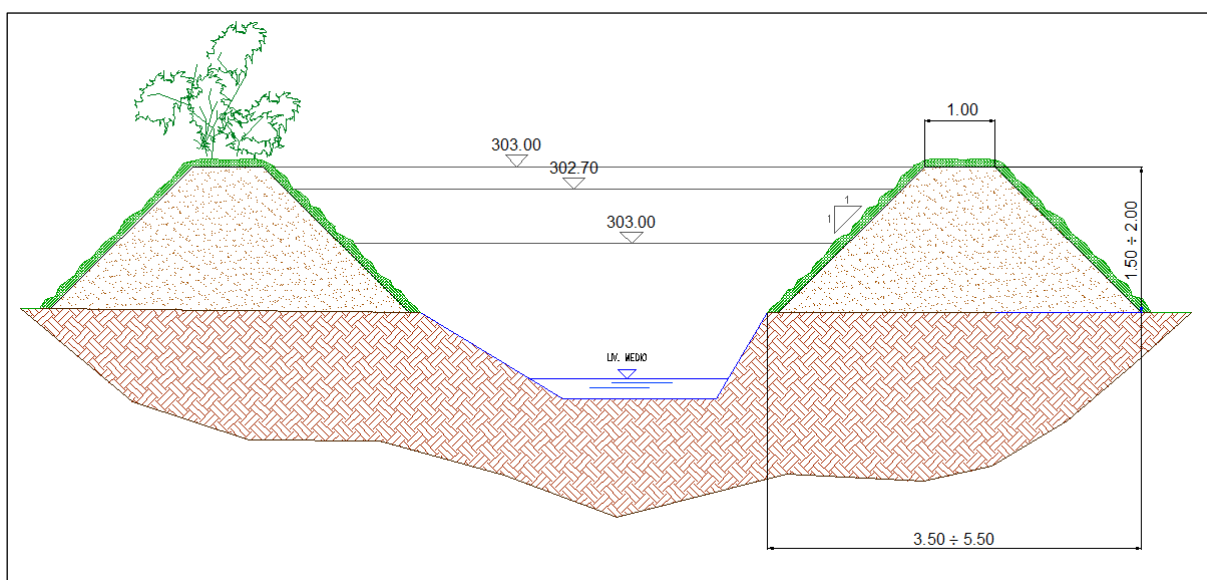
Sezione tipo delle arginature previste per la seconda soluzione progettuale
